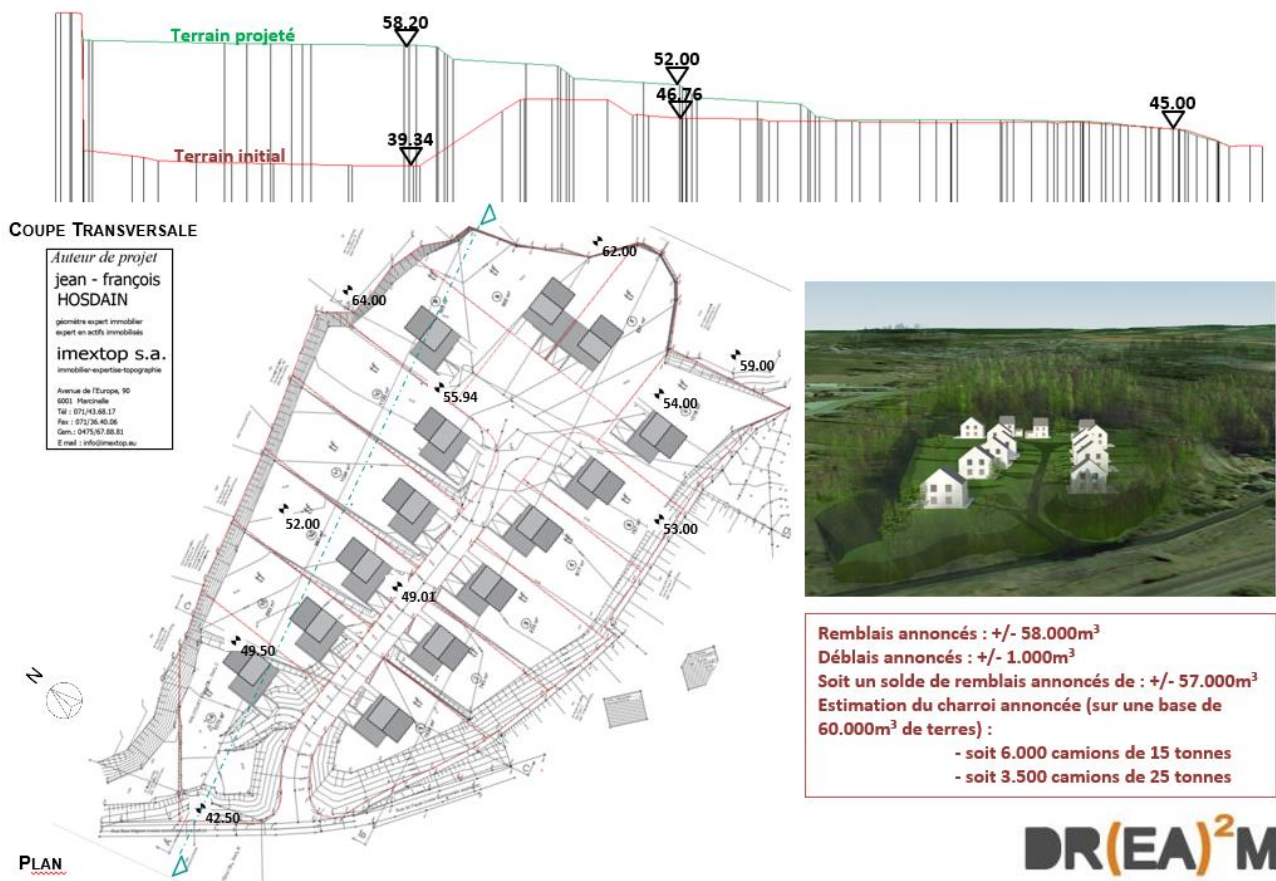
Coupe transversale du projet de modification du relief (Source : DREAM, 2019)
